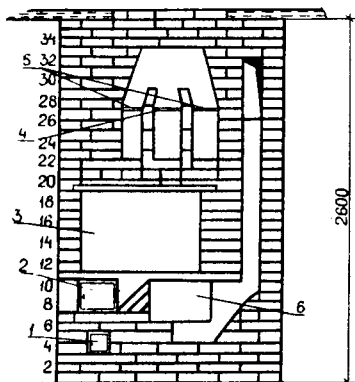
Отопительно-варочная печь угловая № 3, вид спереди: 1 — дверка поддувальная; 2 — дверка топочная; 3 — варочная камера; 4 — задвижка вытяжного канала; 5 — задвижки летняя и зимняя; 6 — духовка
